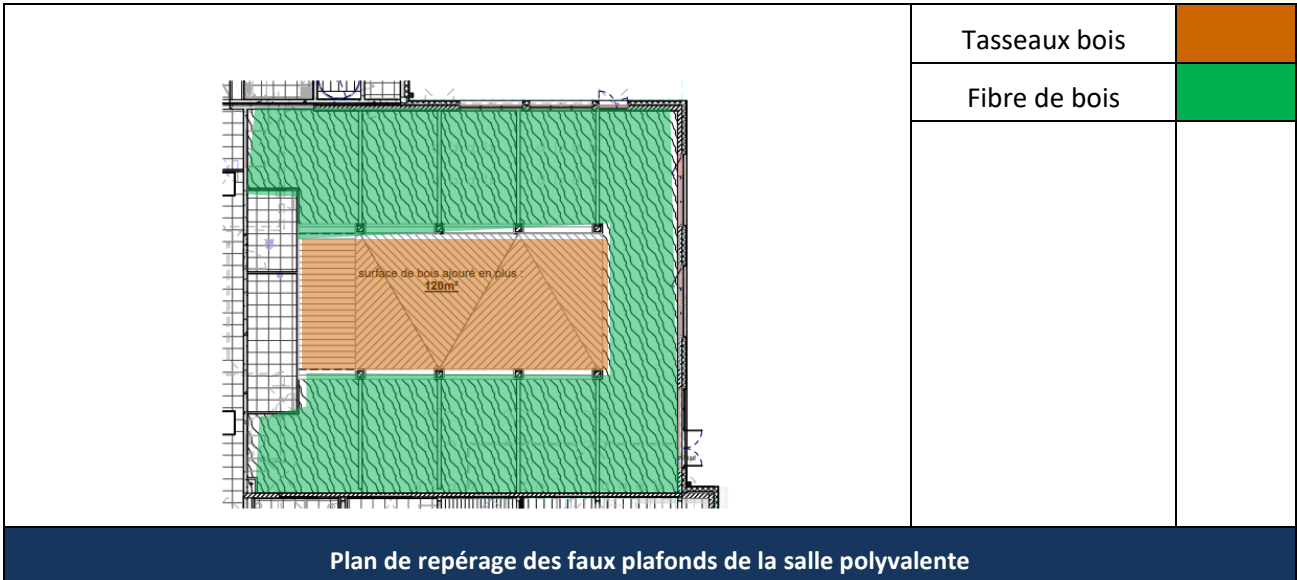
Plan de repérage des faux plafonds – salle polyvalente
